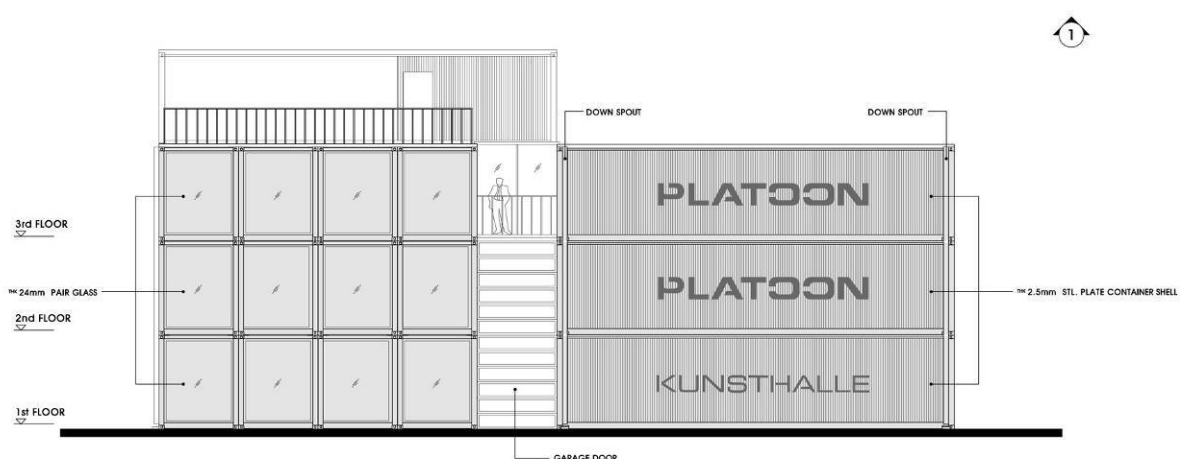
Alçado (s/escala). Platoon Kunsthalle (U-il Architects 2008).
